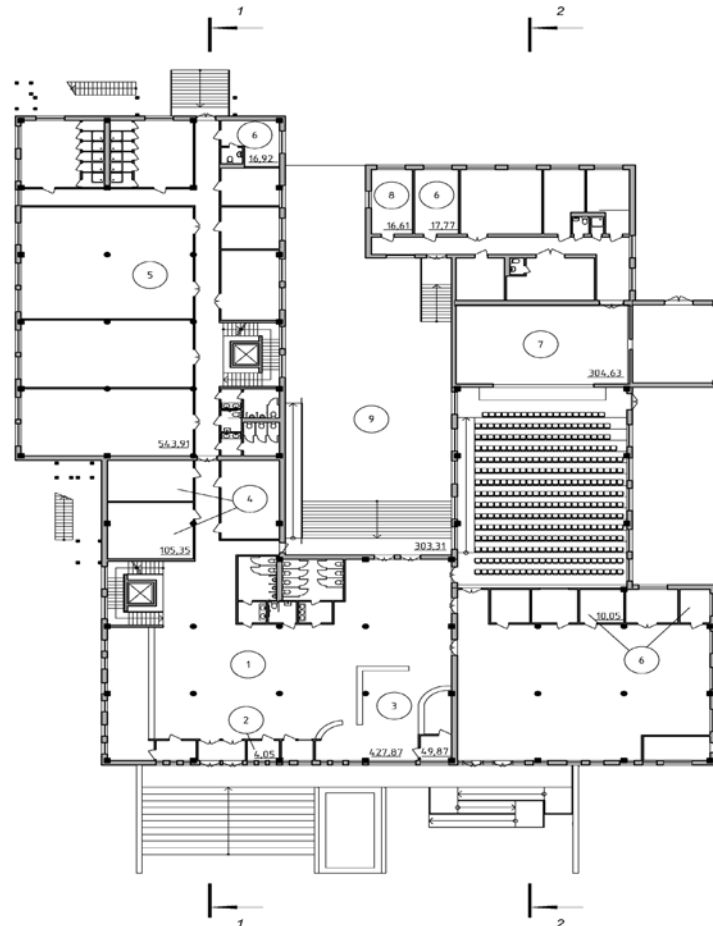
Схематичне зображення першого поверху клубної будівлі:
